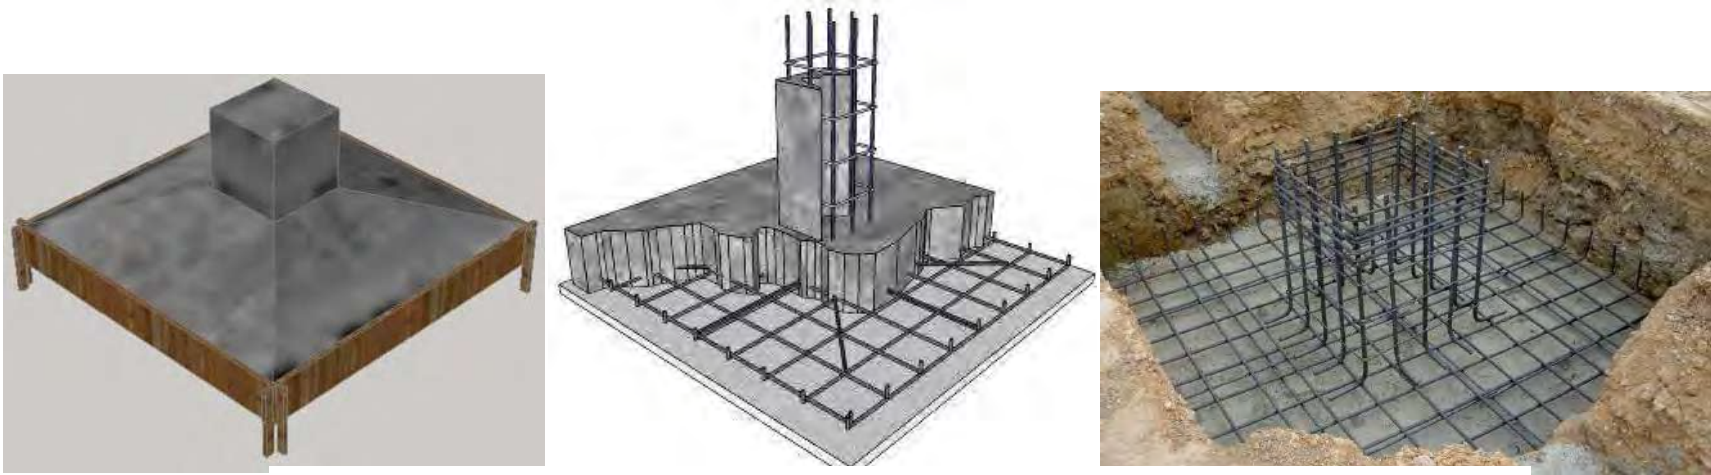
Vista de Zapatas Aisladas De Concreto Armado y Detalles Constructivos de lo Que Serán Las Zapatas Aisladas Que soportaran el Edificio. Fuente: http://www.construmatica.com/construpedia/Zapatas_Aisladas
